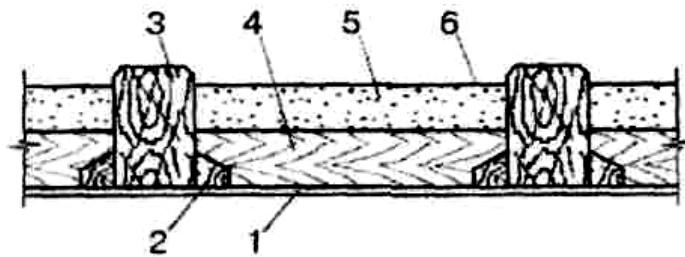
Схеми розбирання перекриття будівель старої споруди: 1 – підшивка стелі; 2 – черепний брус; 3 – дерев'яна балка; 4 – накат; 5 – глиняна засипка; 6 – вапняна кірка
